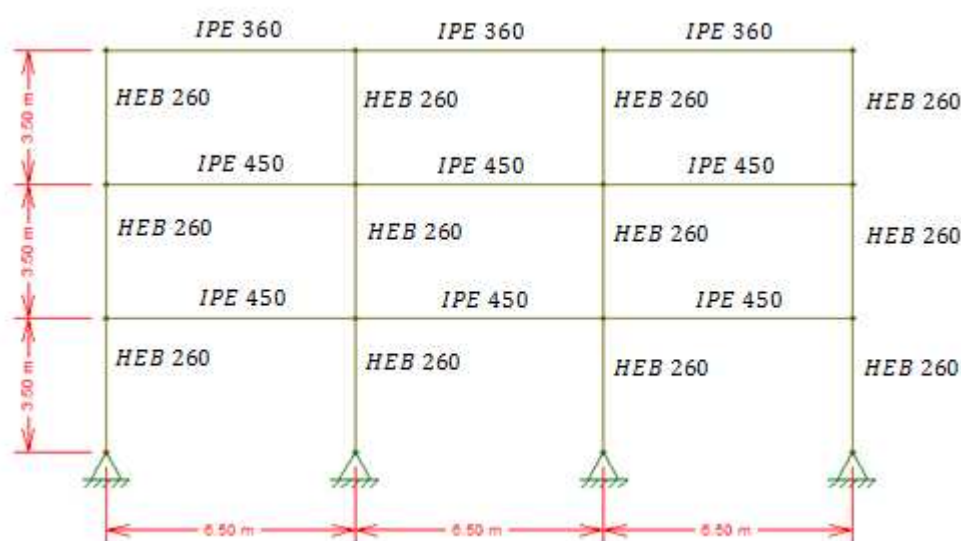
Pórtico com pilares de perfil HEB 260, vigas intermédias de perfil IPE 450 e viga de topo IPE 360
